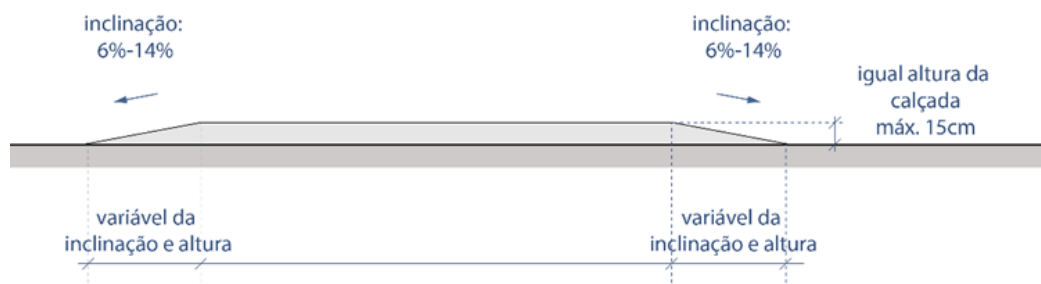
Dimensionamento de faixa elevada para travessia de pedestres em corte.
